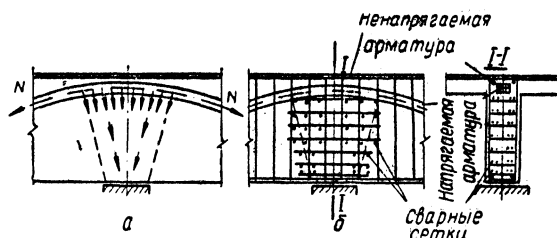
Усиление бетона в пролете балки в местах изменения направления напрягаемой арматуры:
